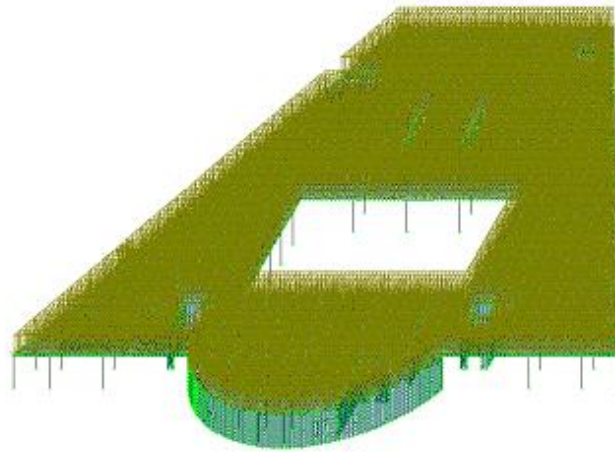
Расчетная схемы плиты перекрытия с приложением всех видов нагрузок
